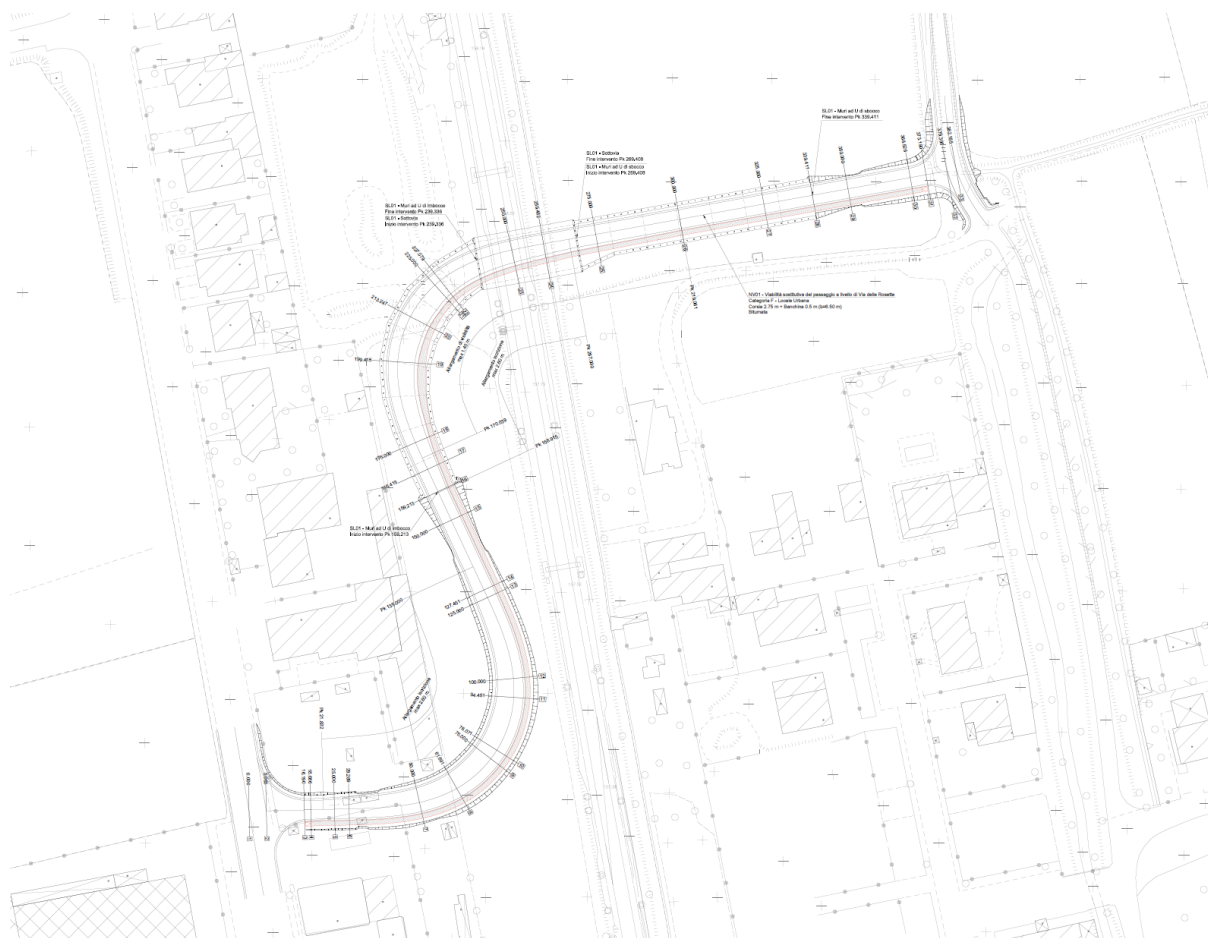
TRACCIATO PLANIMETRICO VIABILITÀ NV01
